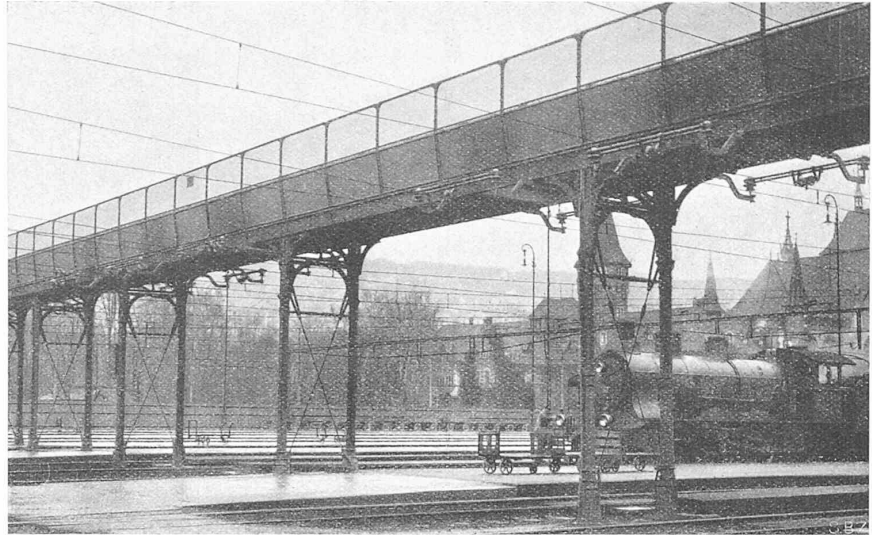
Unterführung von Fahrdrabt und Tragdrabt unter einer Passerelle (Bahnhof Zürich).
